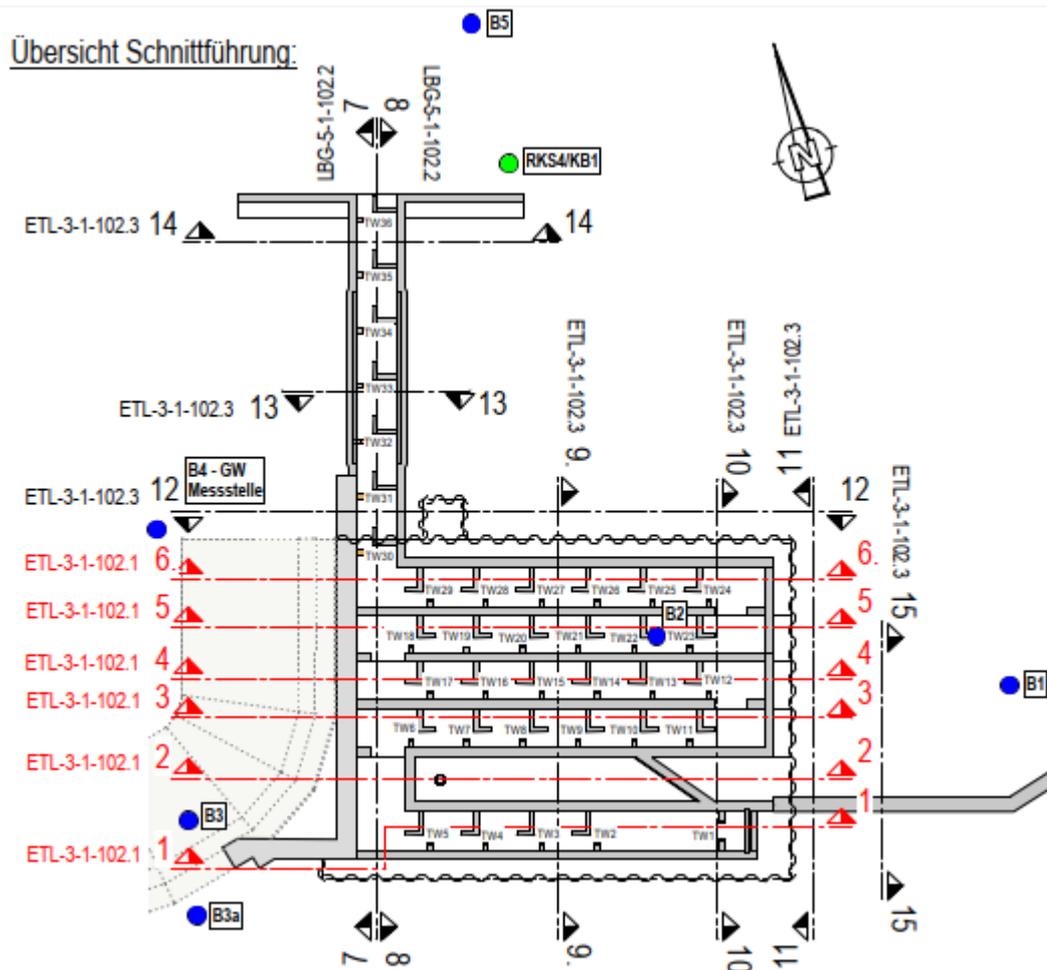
Grundriss Einstiegsbauwerk – Achseneinteilung
